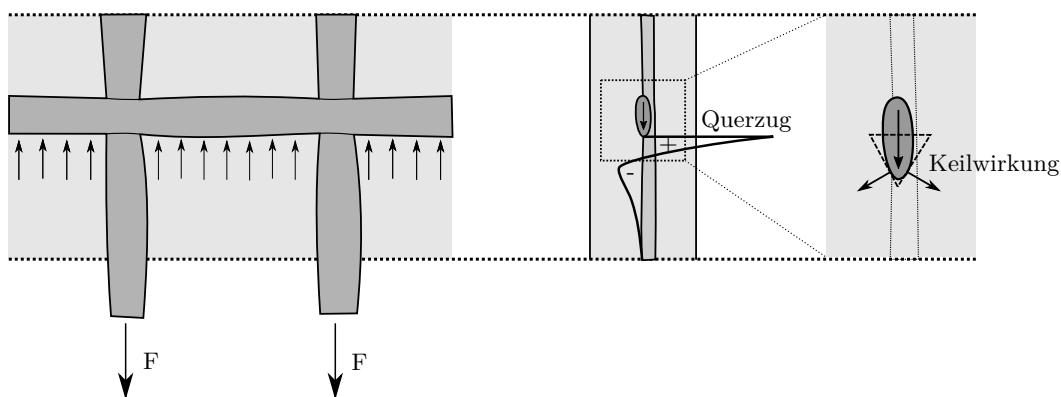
Resultierende Druckstrebe zufolge des Formschlusses der Bewehrung mit dem Beton
